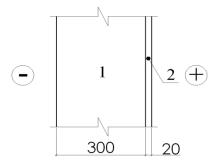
Конструктивная схема наружной стены для производственного здания без утеплителя
